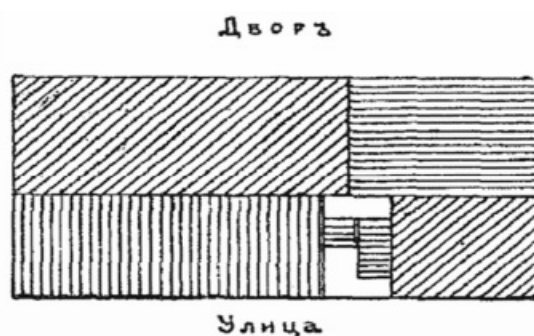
Парадная лестница делит фасад на две неравные части [29]
